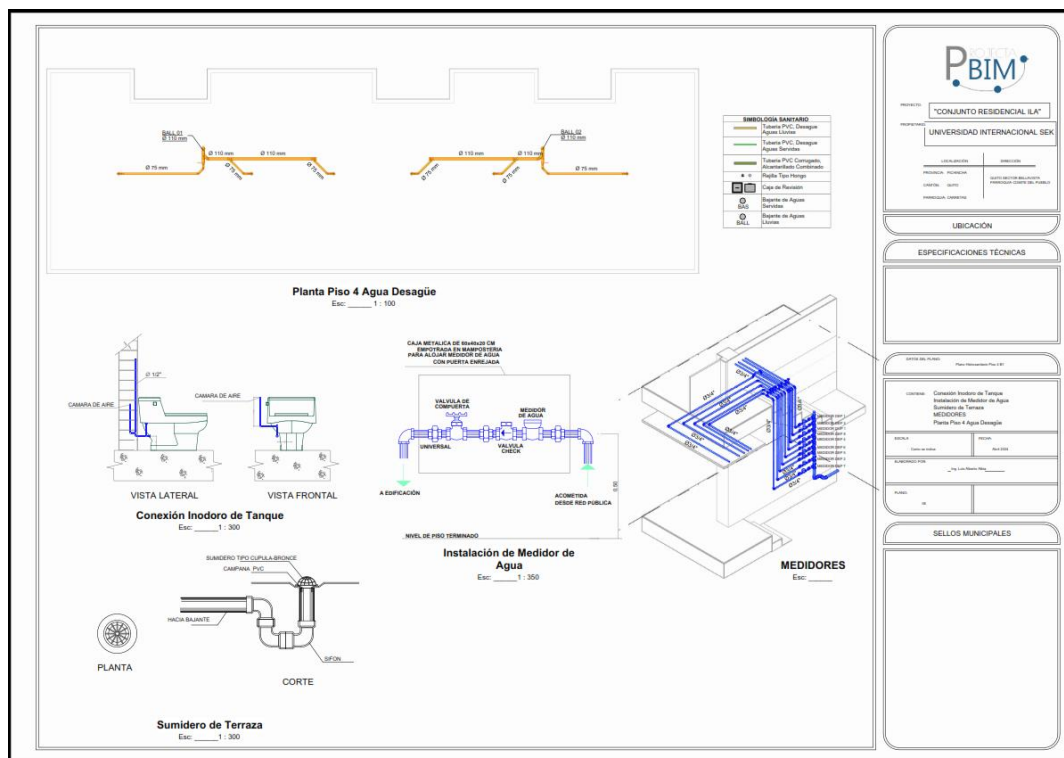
Plano Sanitario Piso 4 Detalles Constructivos
